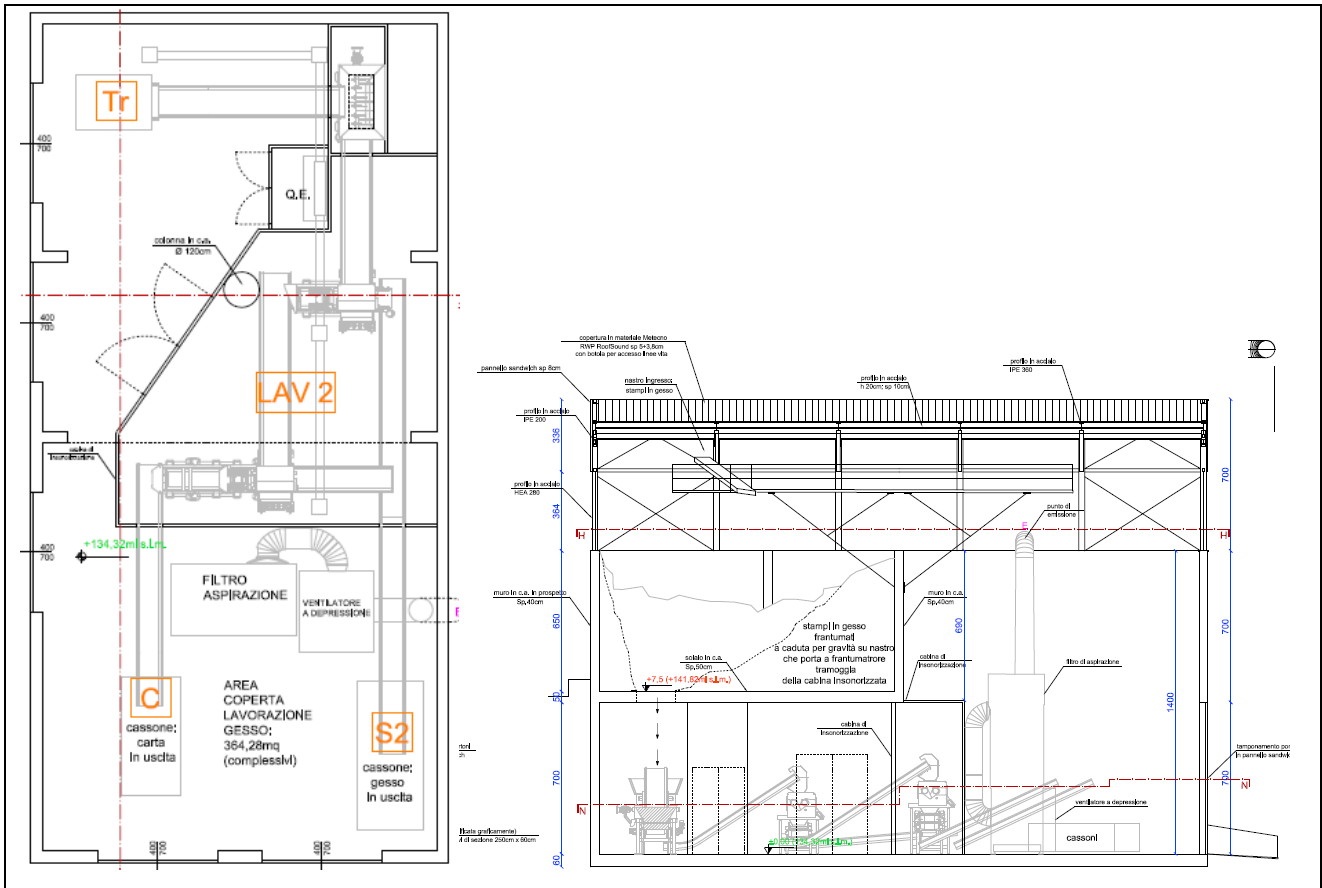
estratto da tavola S9 003\_19 PAUR\_Tav 04 R1\_st prog plan A dim urb prosp\_pe.
